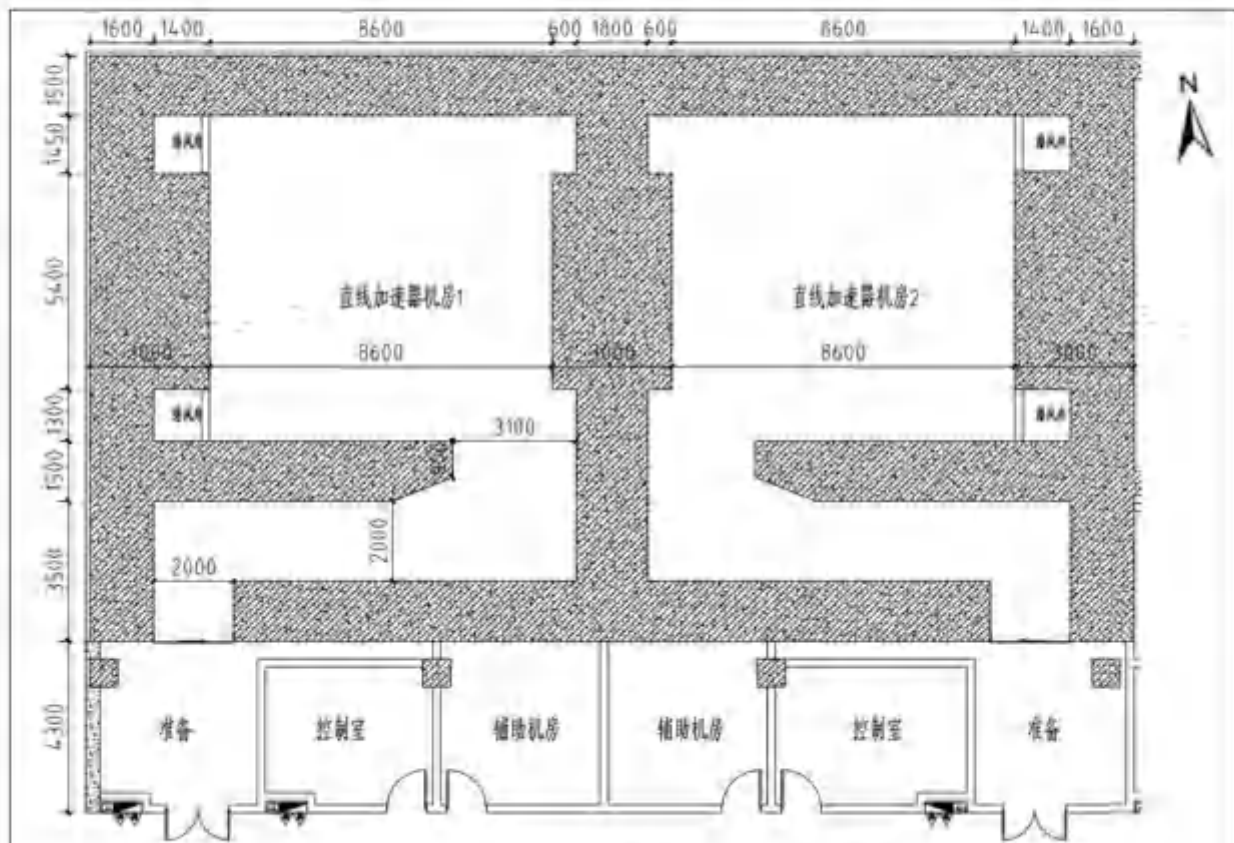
本项目直线加速器机房平面图 (单位: mm)
